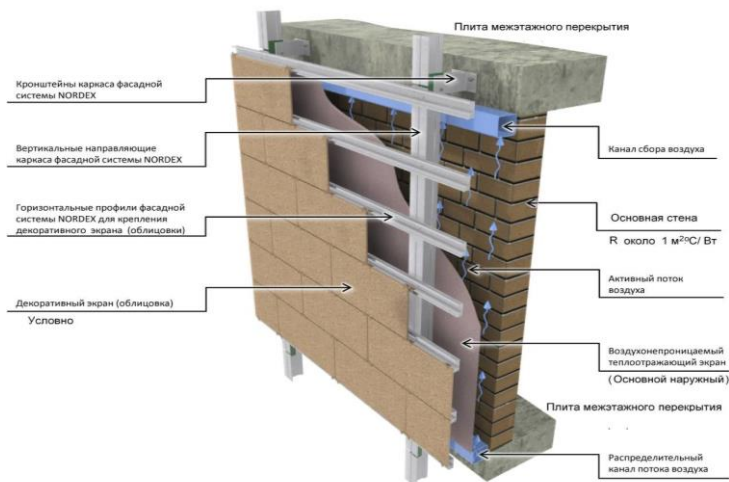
Навесная фасадная система NORDEX с активным энергосбережением (вариант крепления в межэтажные перекрытия)
